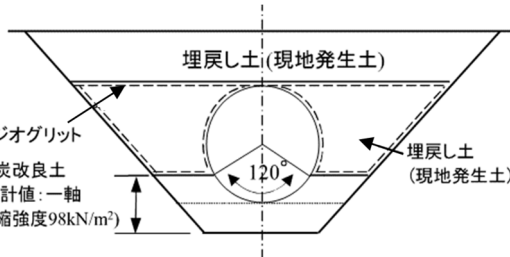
管路の標準断面図（改良土基礎＋ジオグリッドタイプ）
